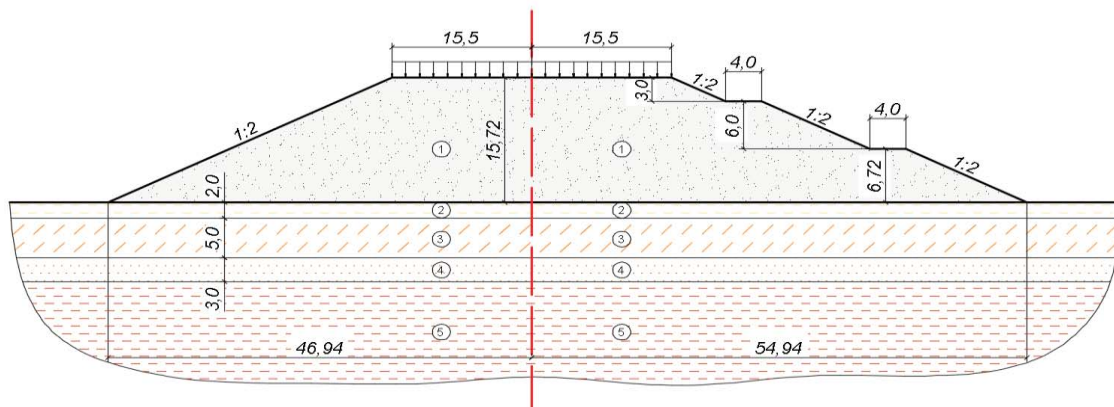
Расчетные конструкции земляного полотна из ЗШС
